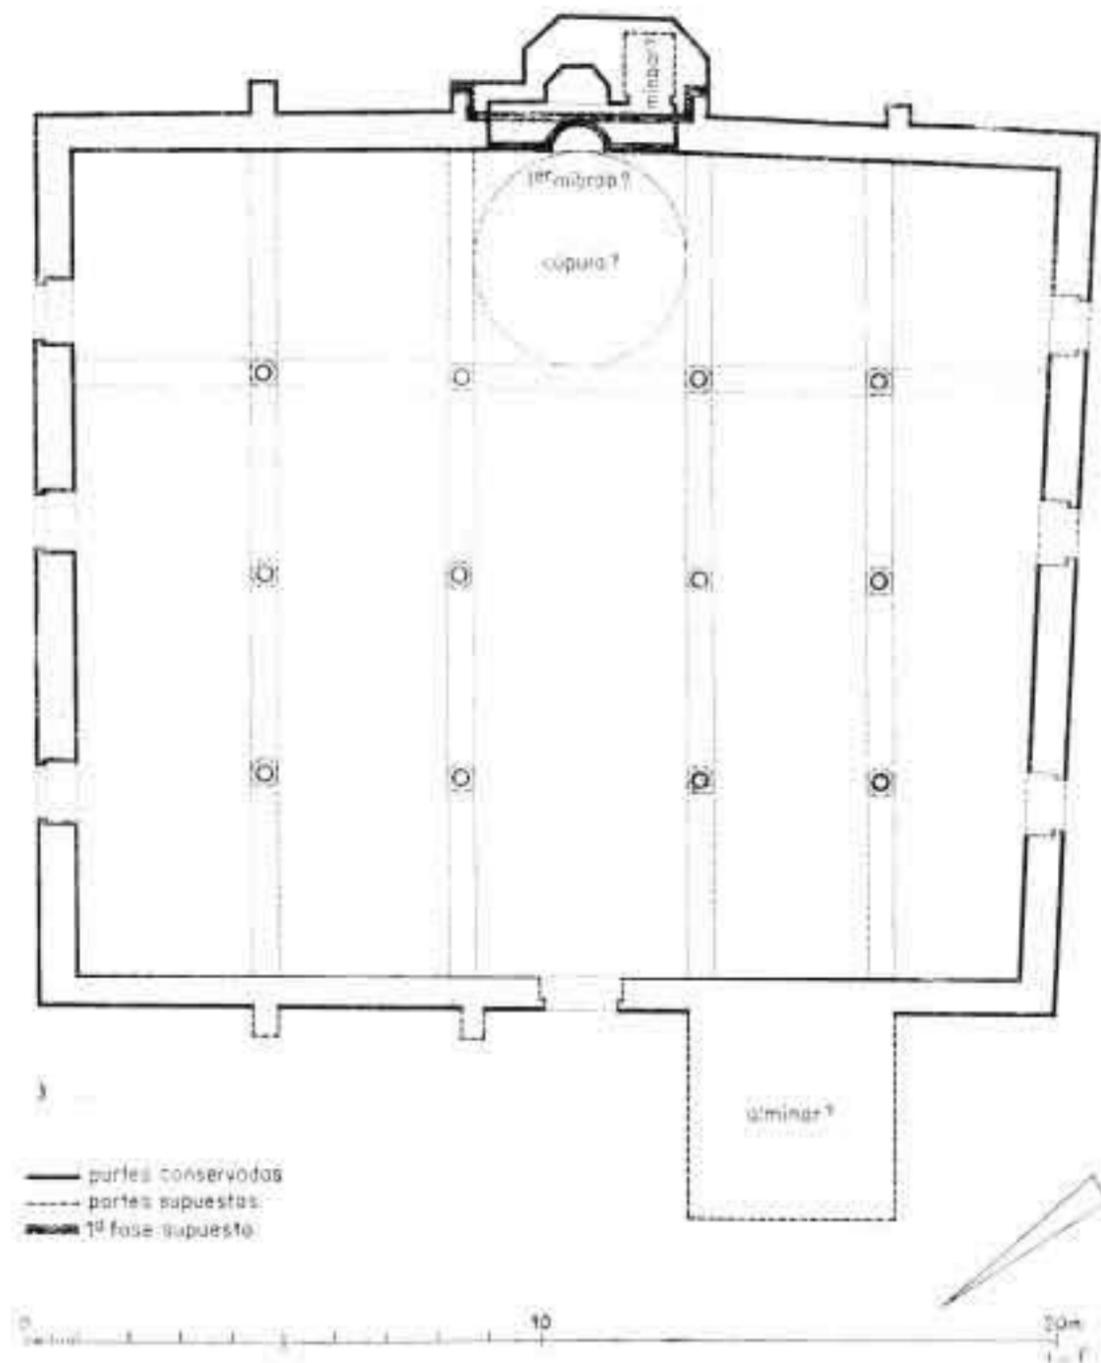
Mértola, mezquita, reconstrucción de la planta (1: 200).
